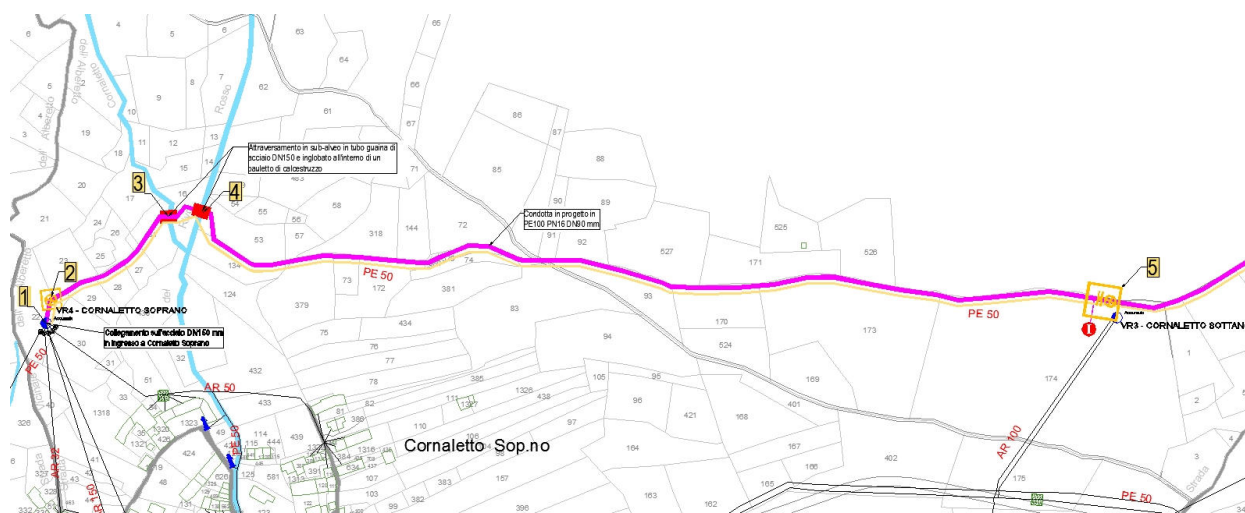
nuova condotta a progetto tra la Sezione 1 e la Sezione 5 su stralcio planimetria catastale.
